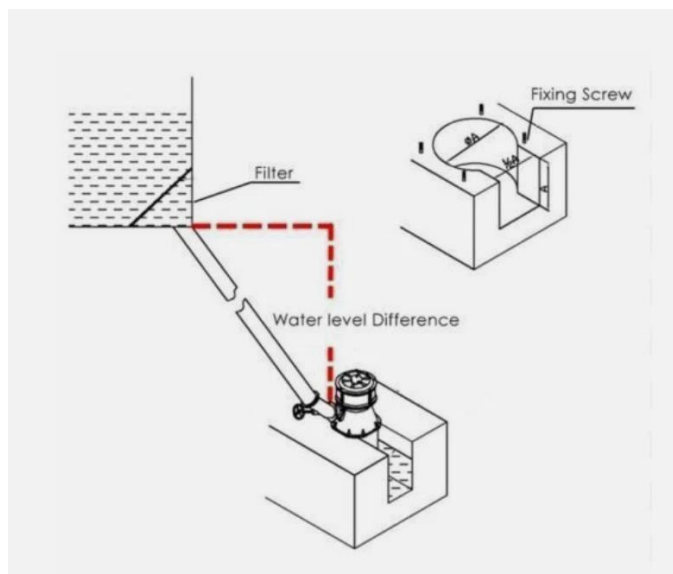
Esquema de instalação da turbina Pelton do fabricante WWS Wasserkraft GmbH.
